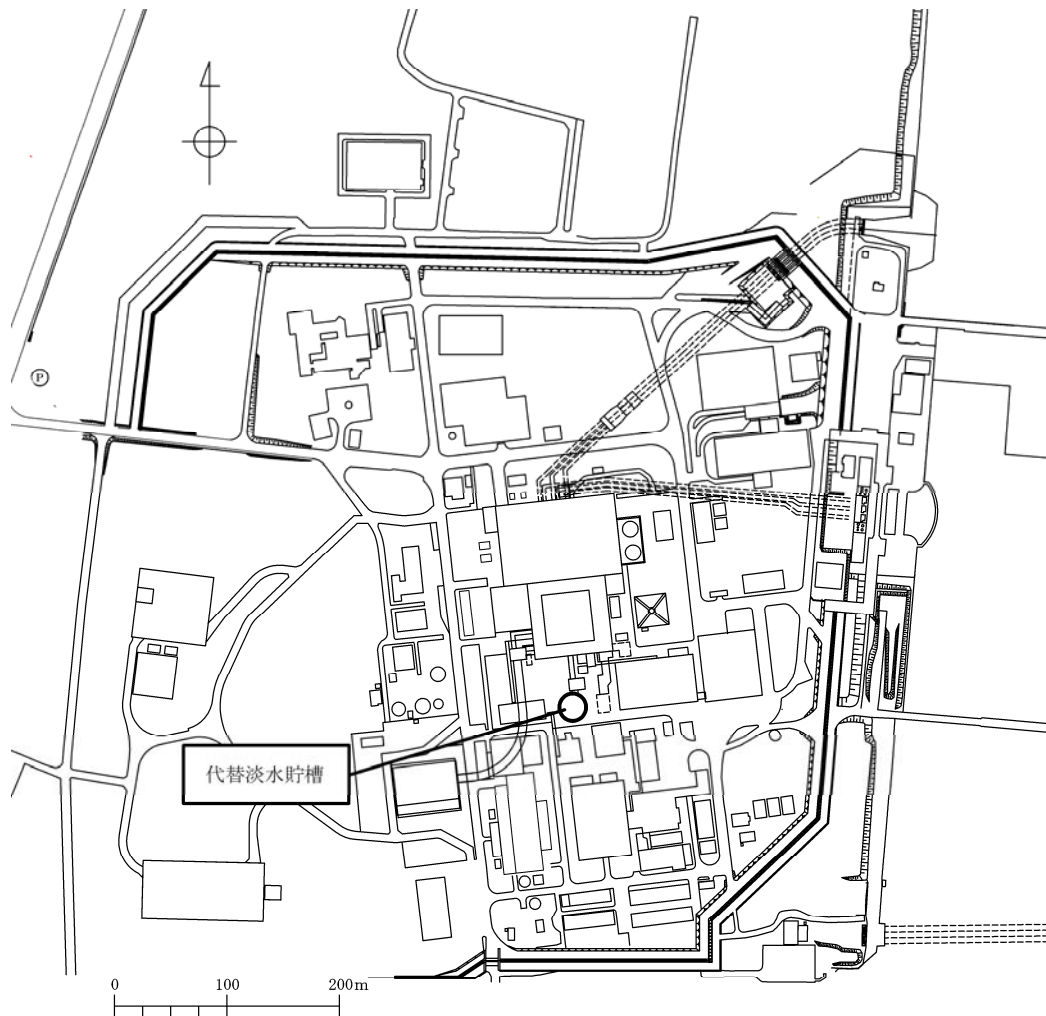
(1) 代替淡水貯槽 平面配置図 (全体平面図)
